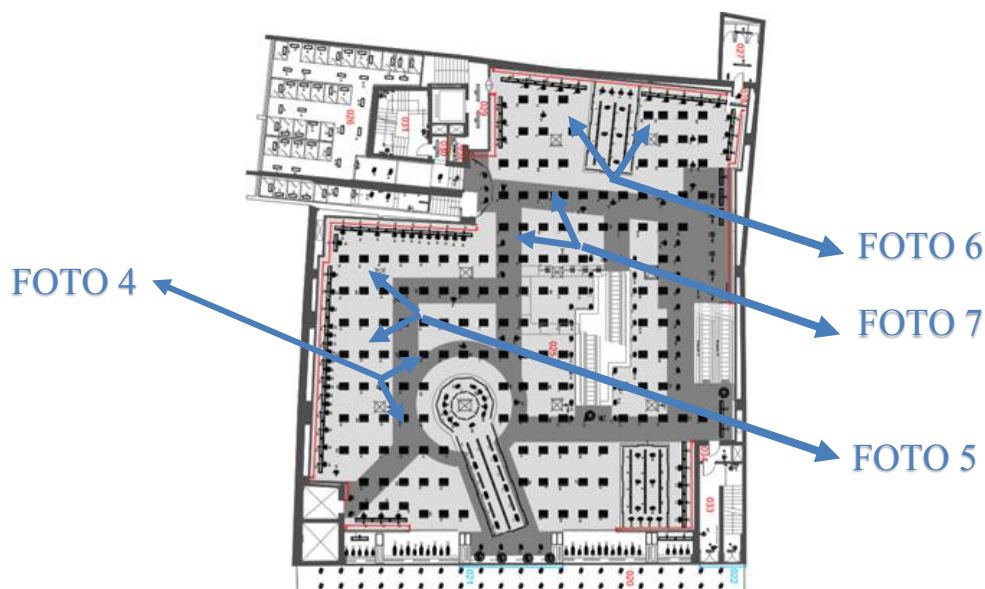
Planta baixa do pavimento térreo. Fonte: Empresa contratada, 2010.
